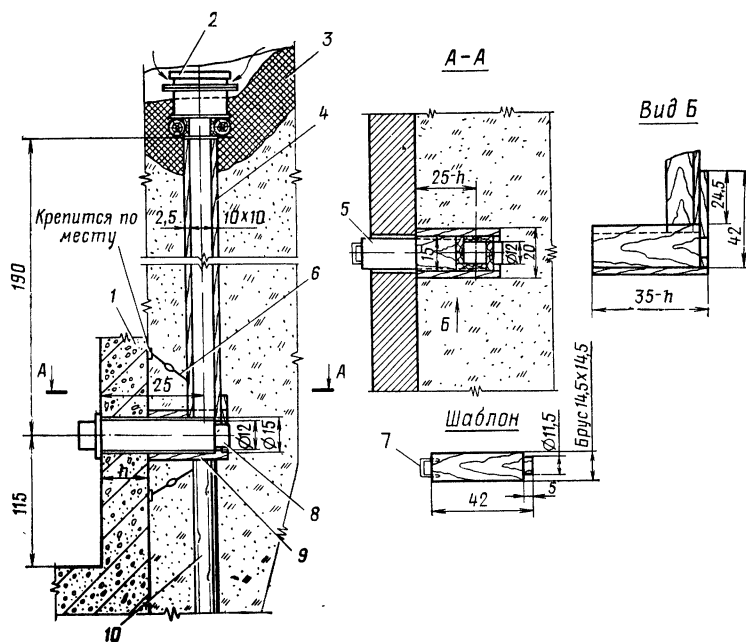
Установка воздухозаборного короба из досок при отсутствии металлического воздуховода из комплекта ФВА-100/50:
